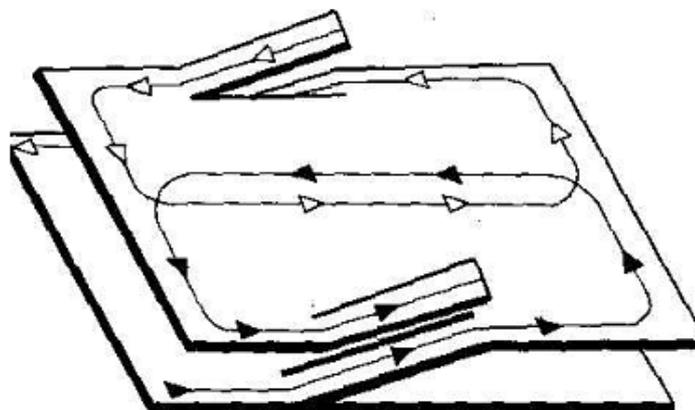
Rampas retas separadas paralelas (Neufert, 1993)
